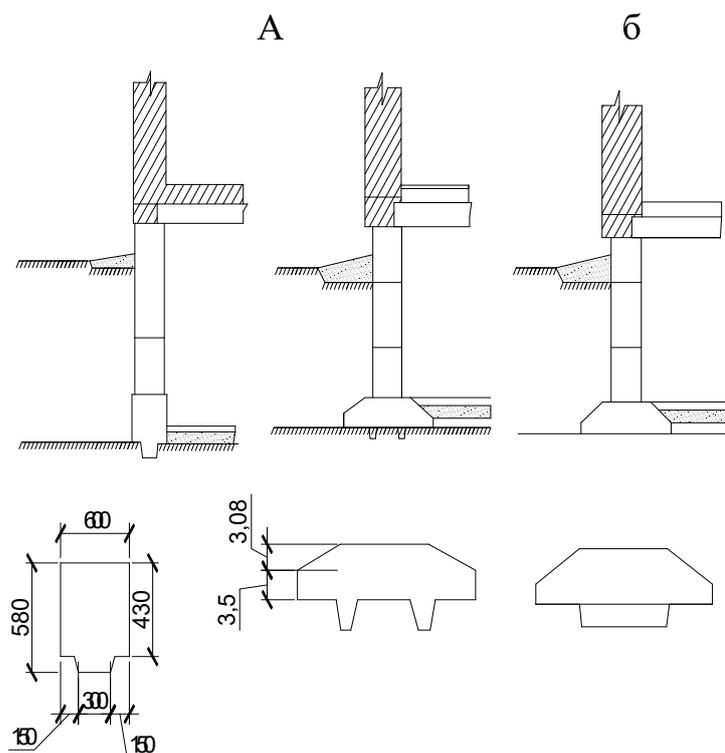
Ленточные сборные фундаменты: а – бетонные ребристые блоки; б – типовые блоки ФБС
